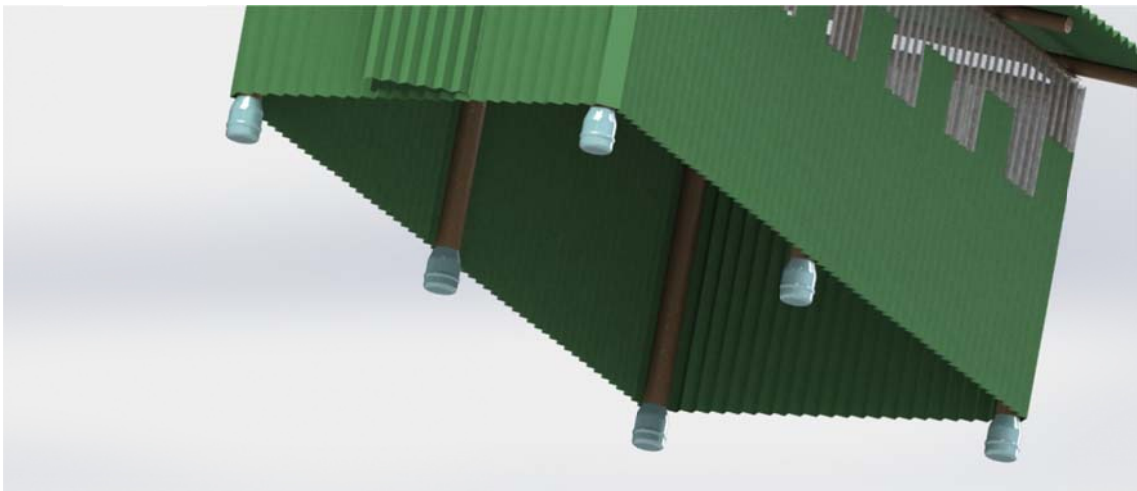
Detalle arranque pilares de bambú. (Fuente: Elaboración propia).
